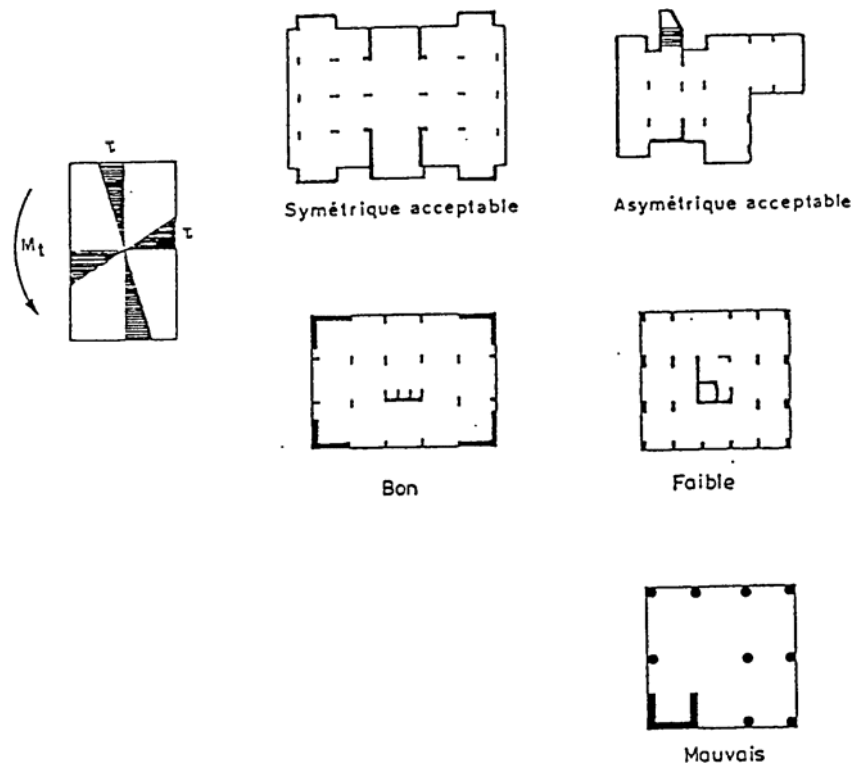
b) Dispositions des contreventements pour la reprise de la torsion.
